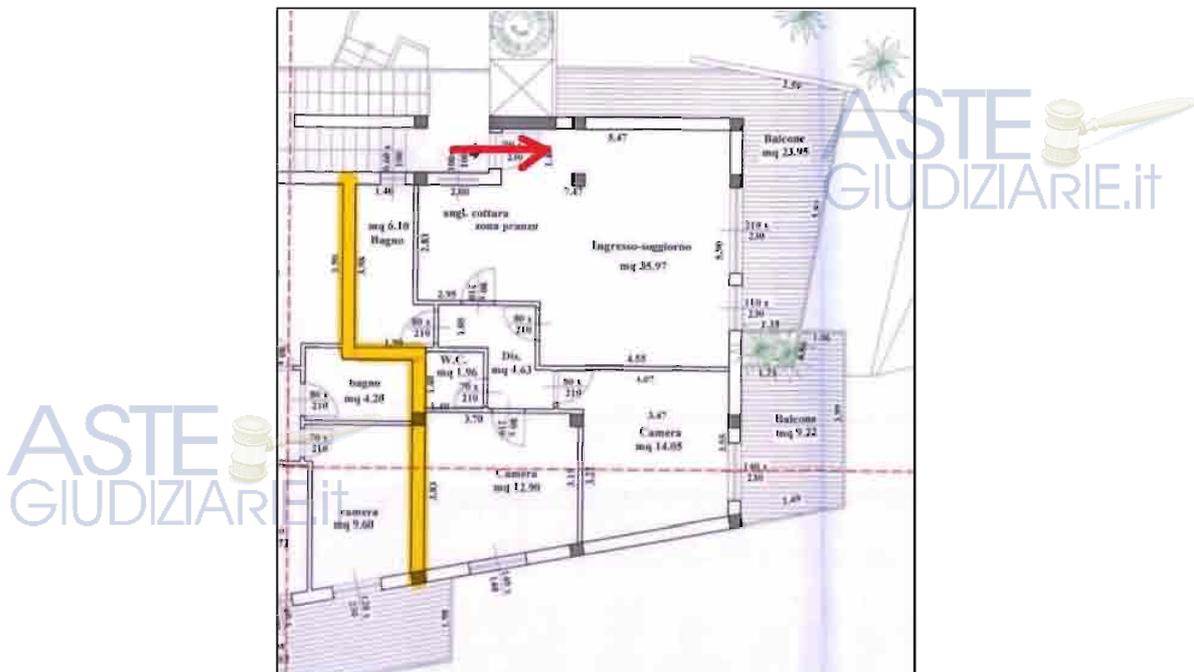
Immobile A_21, appartamento piano 1° (Planimetria di progetto)
